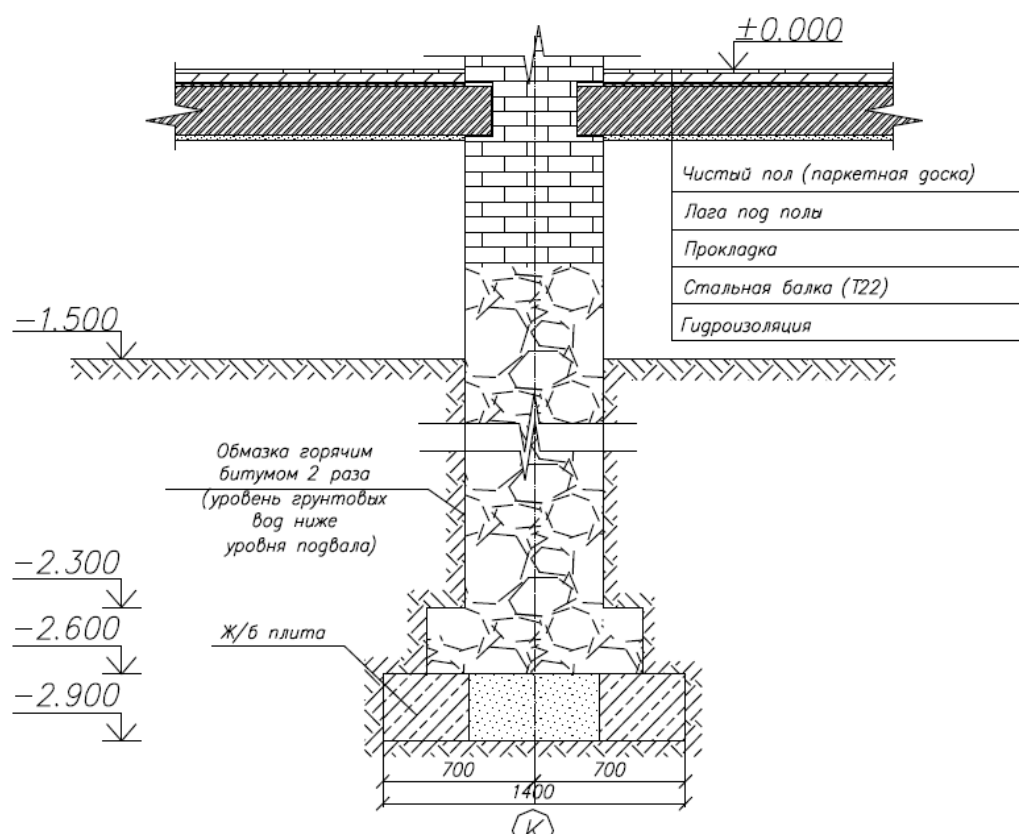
Усиление фундамента под внутреннюю стену с использованием железобетонных вставок и защита стены фундамента обмазочной гидроизоляцией
